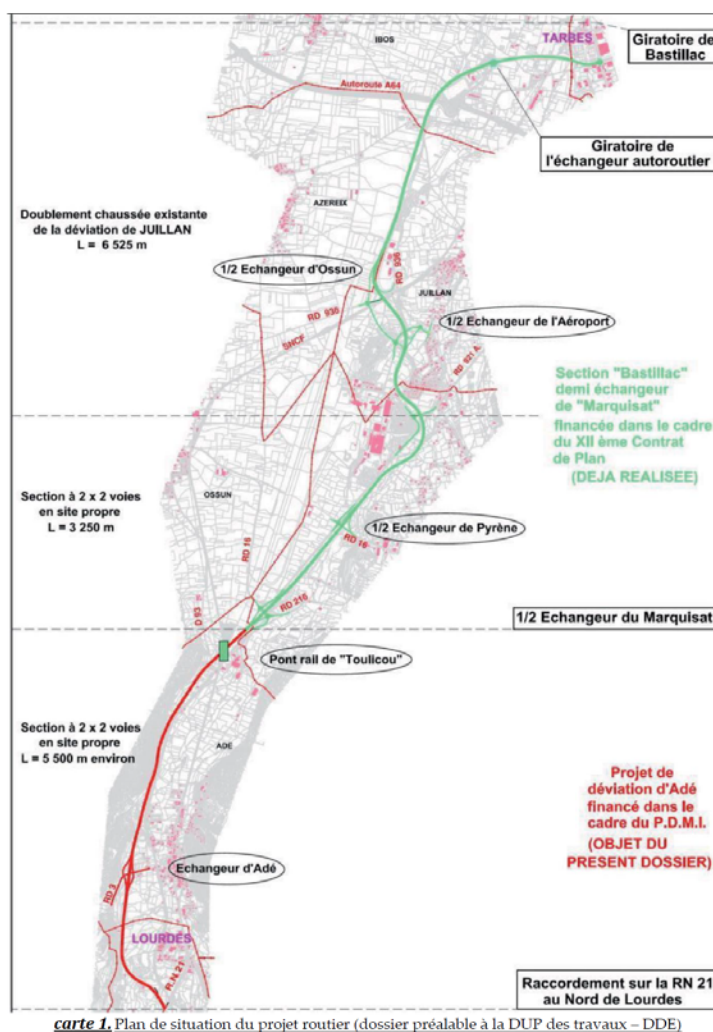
plan de situation du projet routier (source : étude d'impact)
